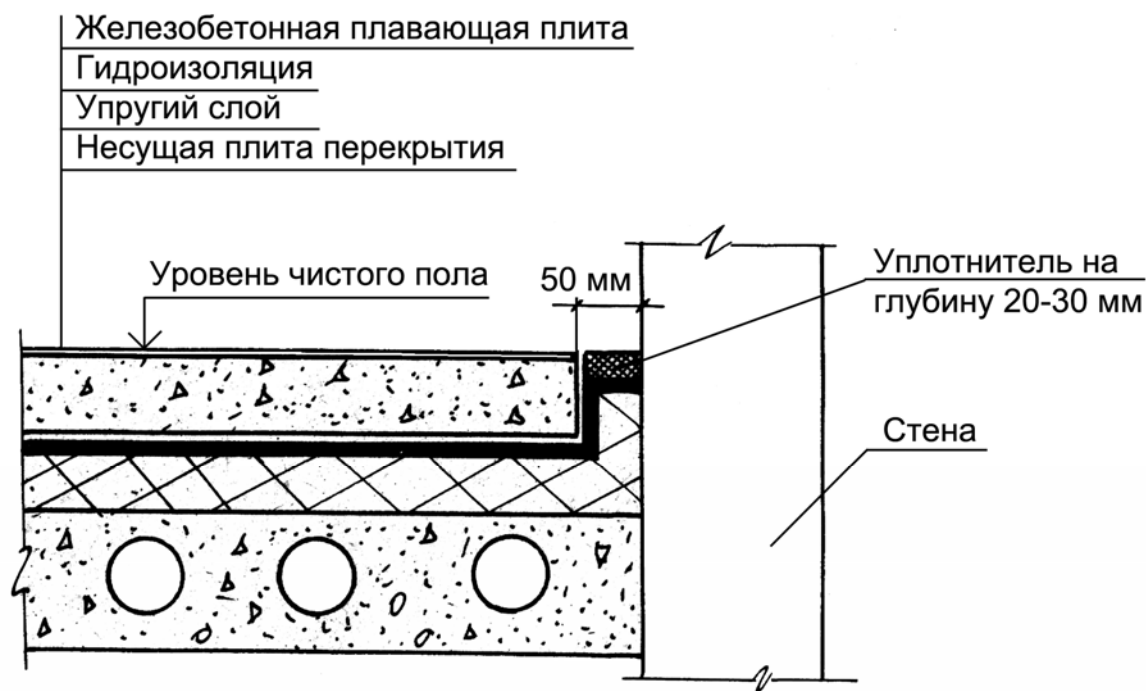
Конструкция пола на упругом основании и его стыка со стеной
